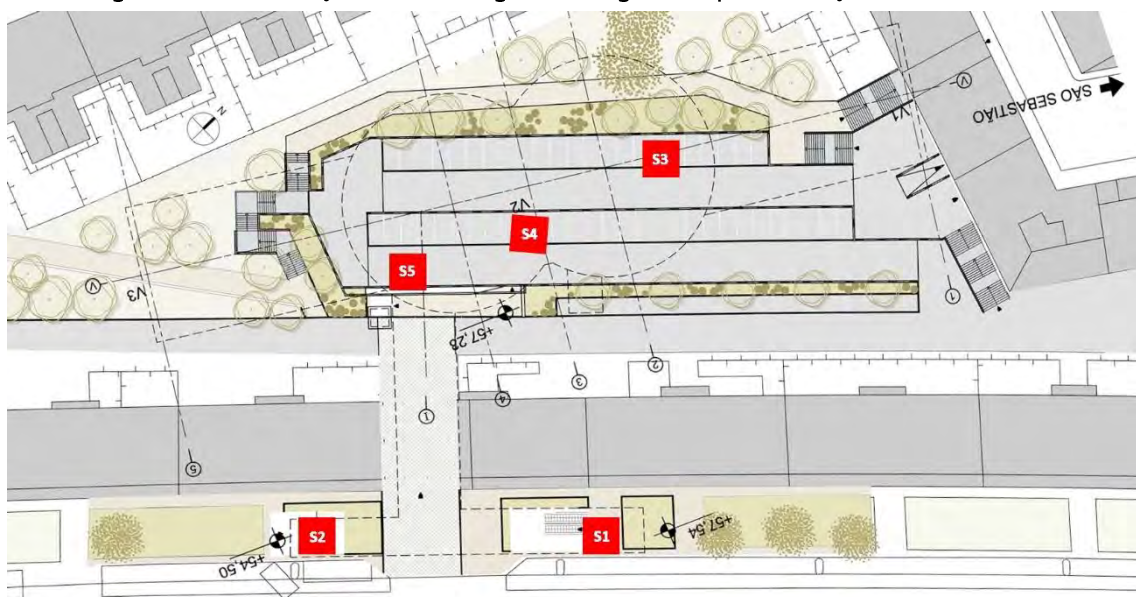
Localização das mesmas 5 sondagens sobre a planta de projeto.
